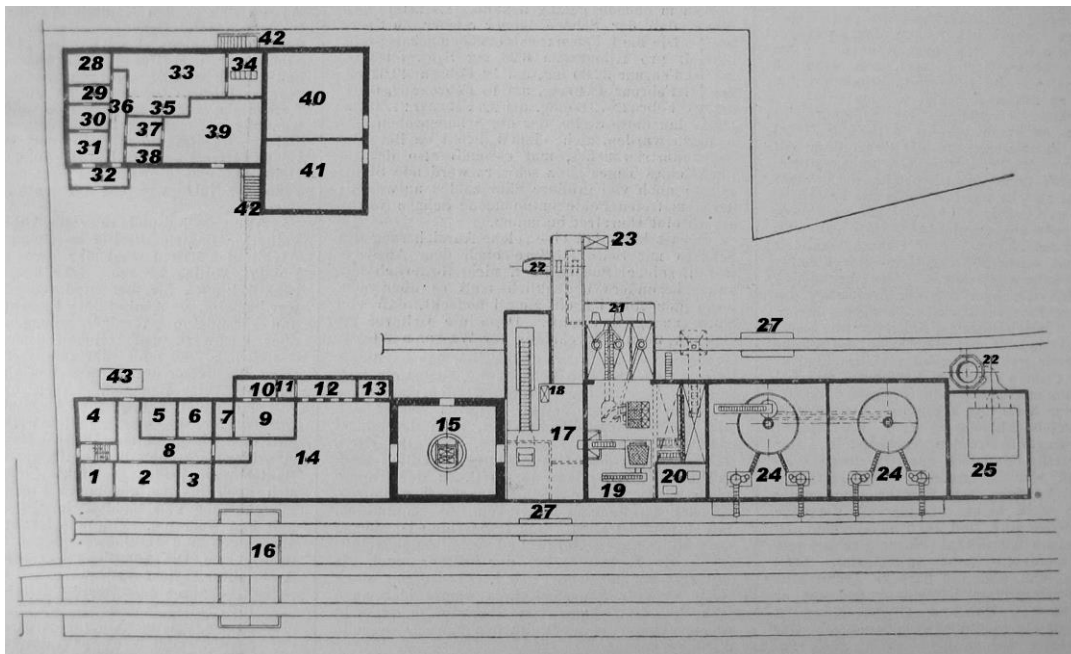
Lageplan der Tagesanlage – Neunummerierung nach obigem Situationsplan
